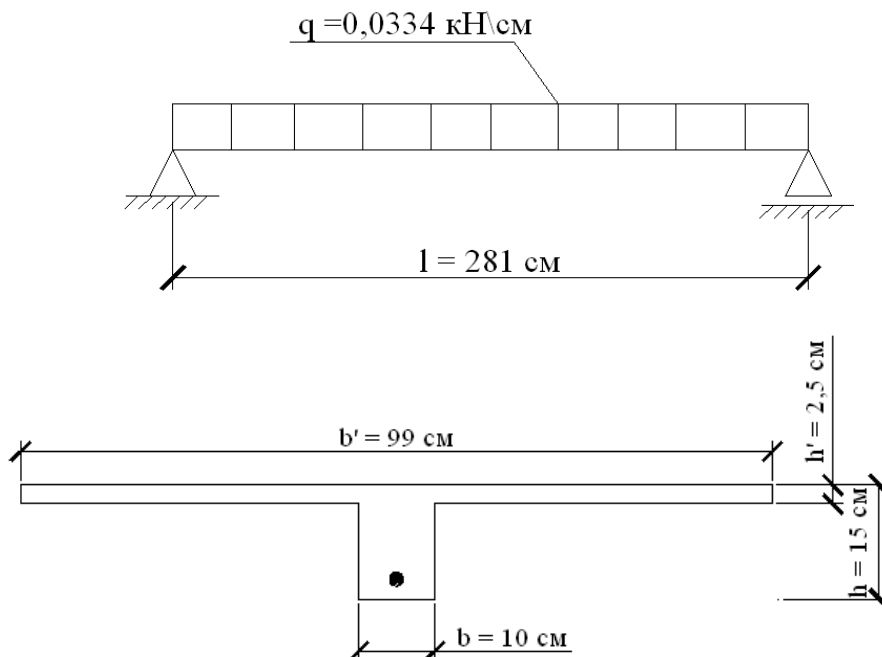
Розрахункова схема та розрахунковий поперечний переріз поперечного ребра
